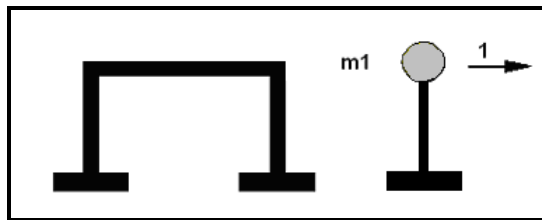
Modelo de masas concentradas de un pórtico plano.
